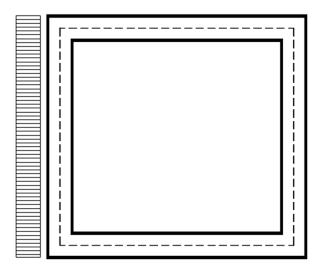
Schema tipo spinta carico accidentale su parete sinistra
